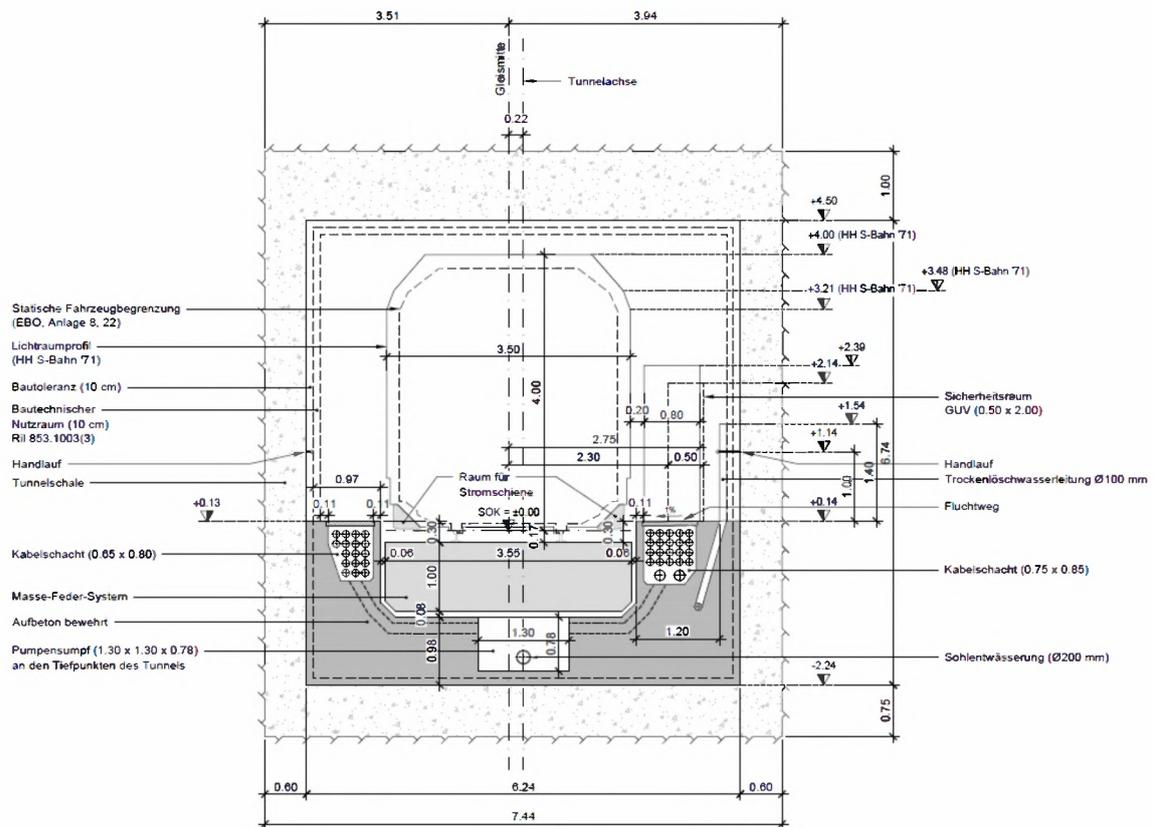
Regelquerschnitt Tunnel Offene Bauweise einspurige Gleisführung
